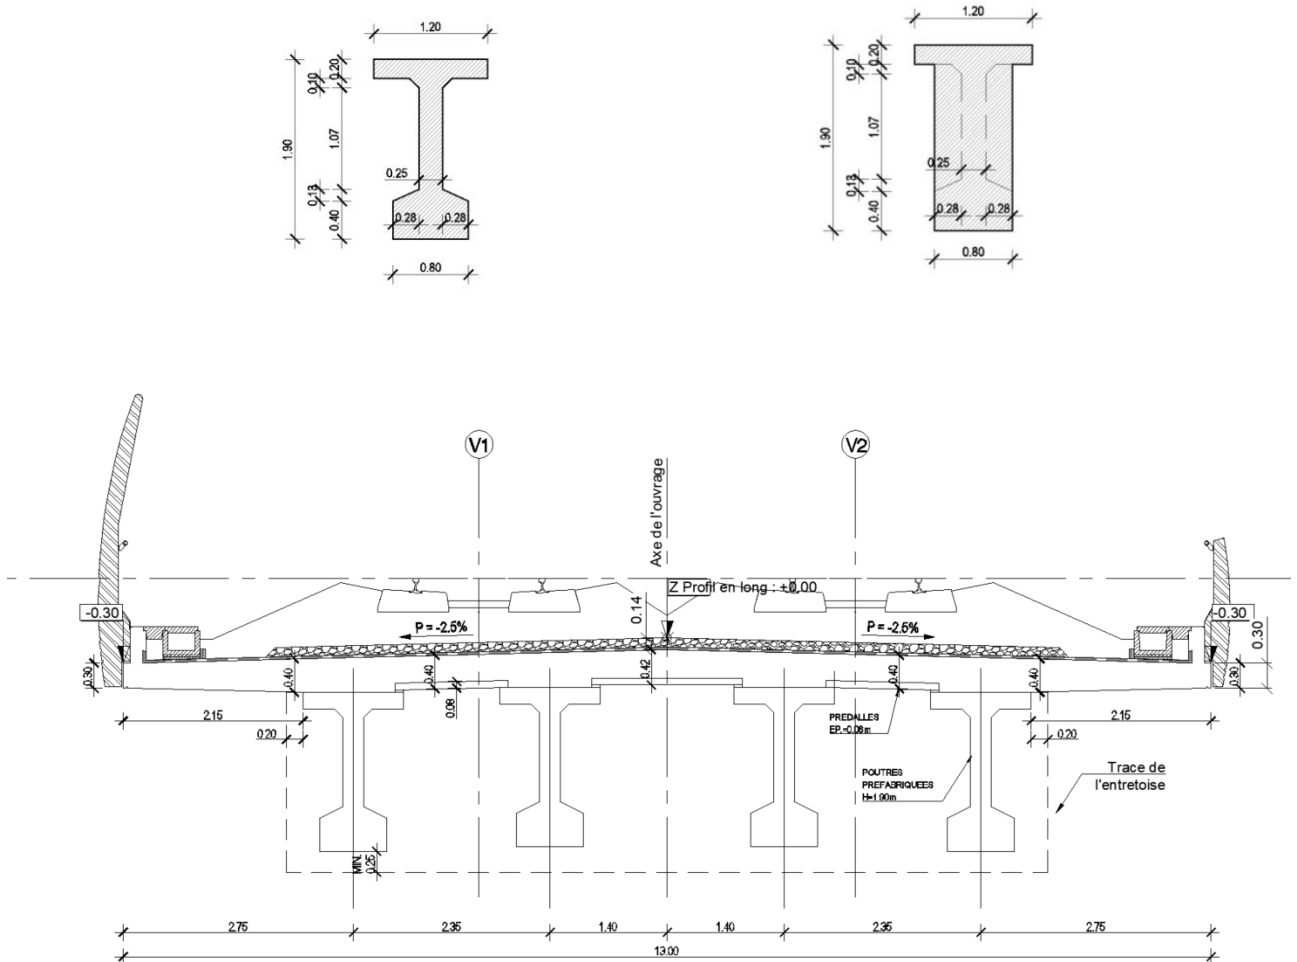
Corte transversal do tabuleiro e geometria das vigas
